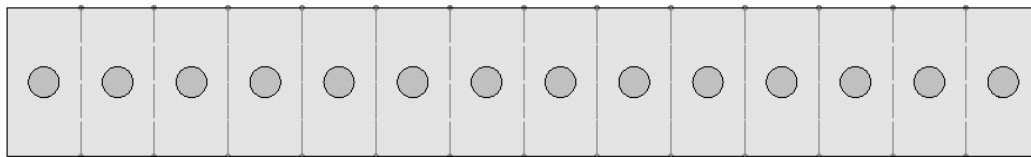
Vista de planta de la distribución 2 de los ventiladores de techo.
